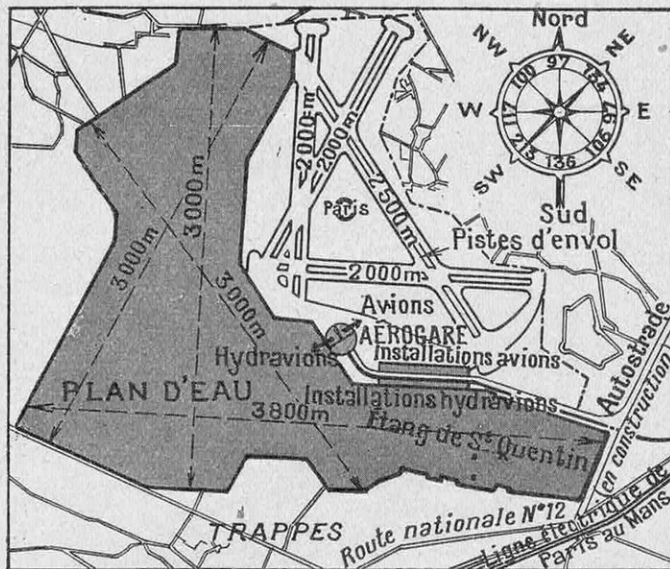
PLAN D'ENSEMBLE DE L'AÉROPORT TRANSATLANTIQUE DE TRAPPES, ACTUELLEMENT EN PROJET, MONTRANT LES PISTES D'ENVOI POUR LES AVIONS TERRESTRES ET LE PLAN D'EAU POUR HYDRAVIONS
